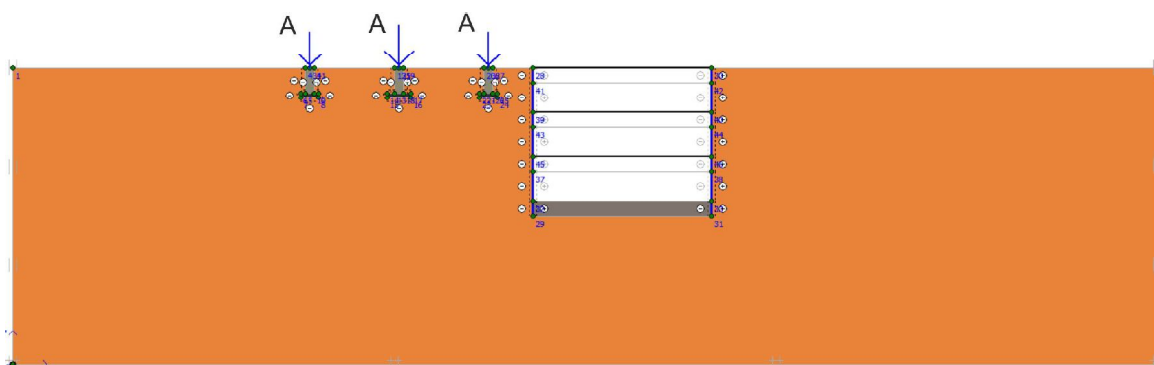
Расчетная модель устройства котлована открытым методом 2-м способом (с устройством плиты jet-grouting по дну котлована)
